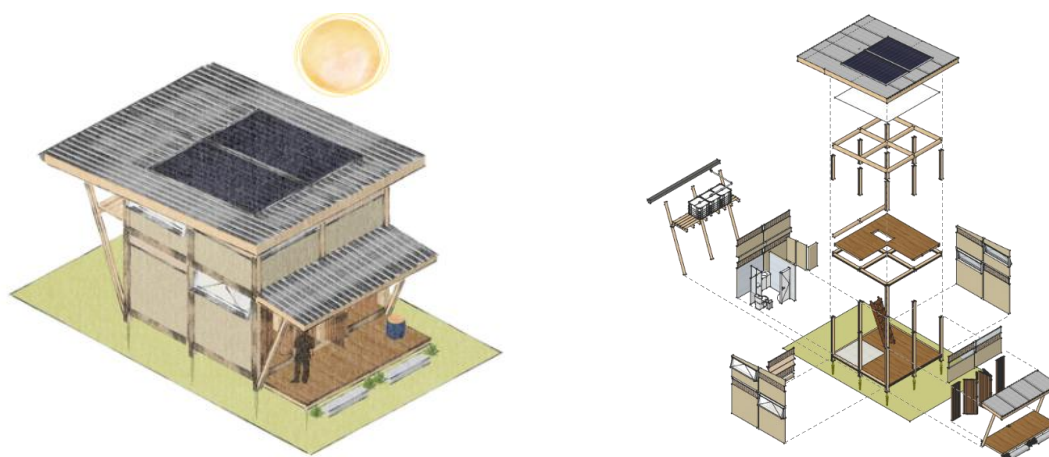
Vista isométrica e vista explodida. Fonte: Autores.
